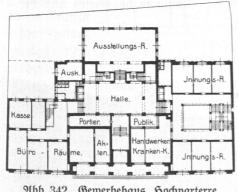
Gewerbehaus, Hochparterre, Grundriß.
